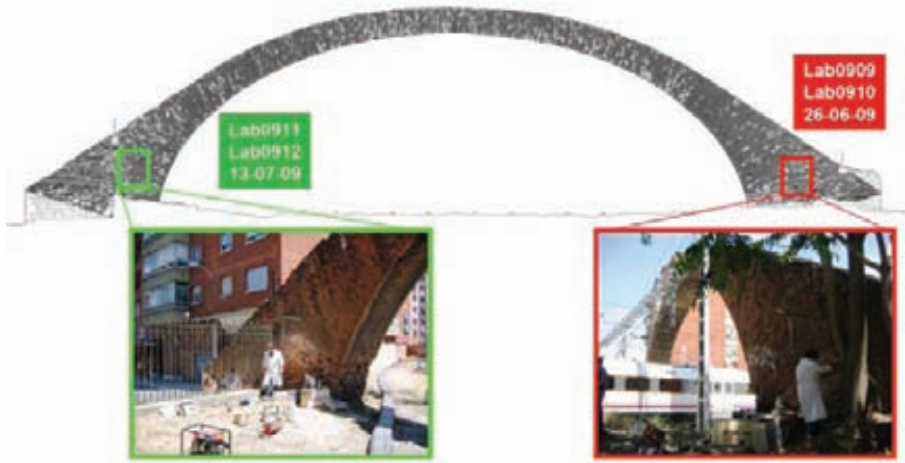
Localización de los ensayos de gato plano (alzado Oeste)
